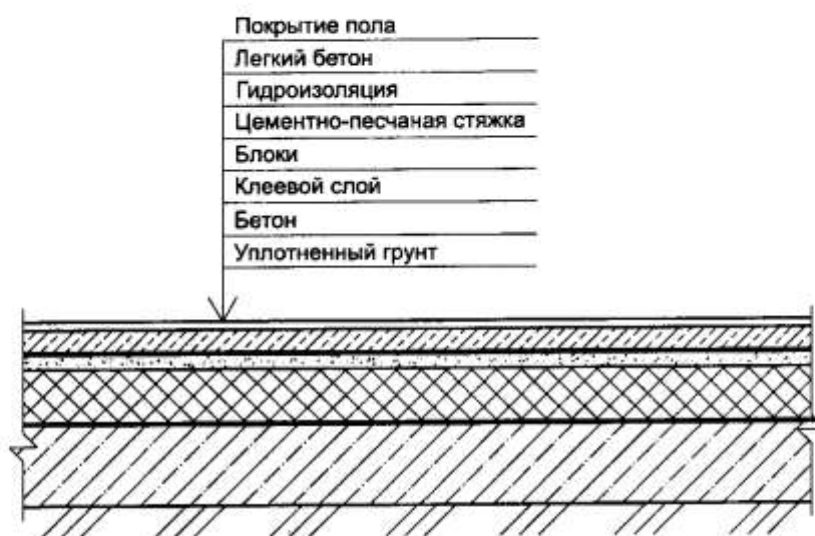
Тепловая изоляция пола из блоков по грунту
